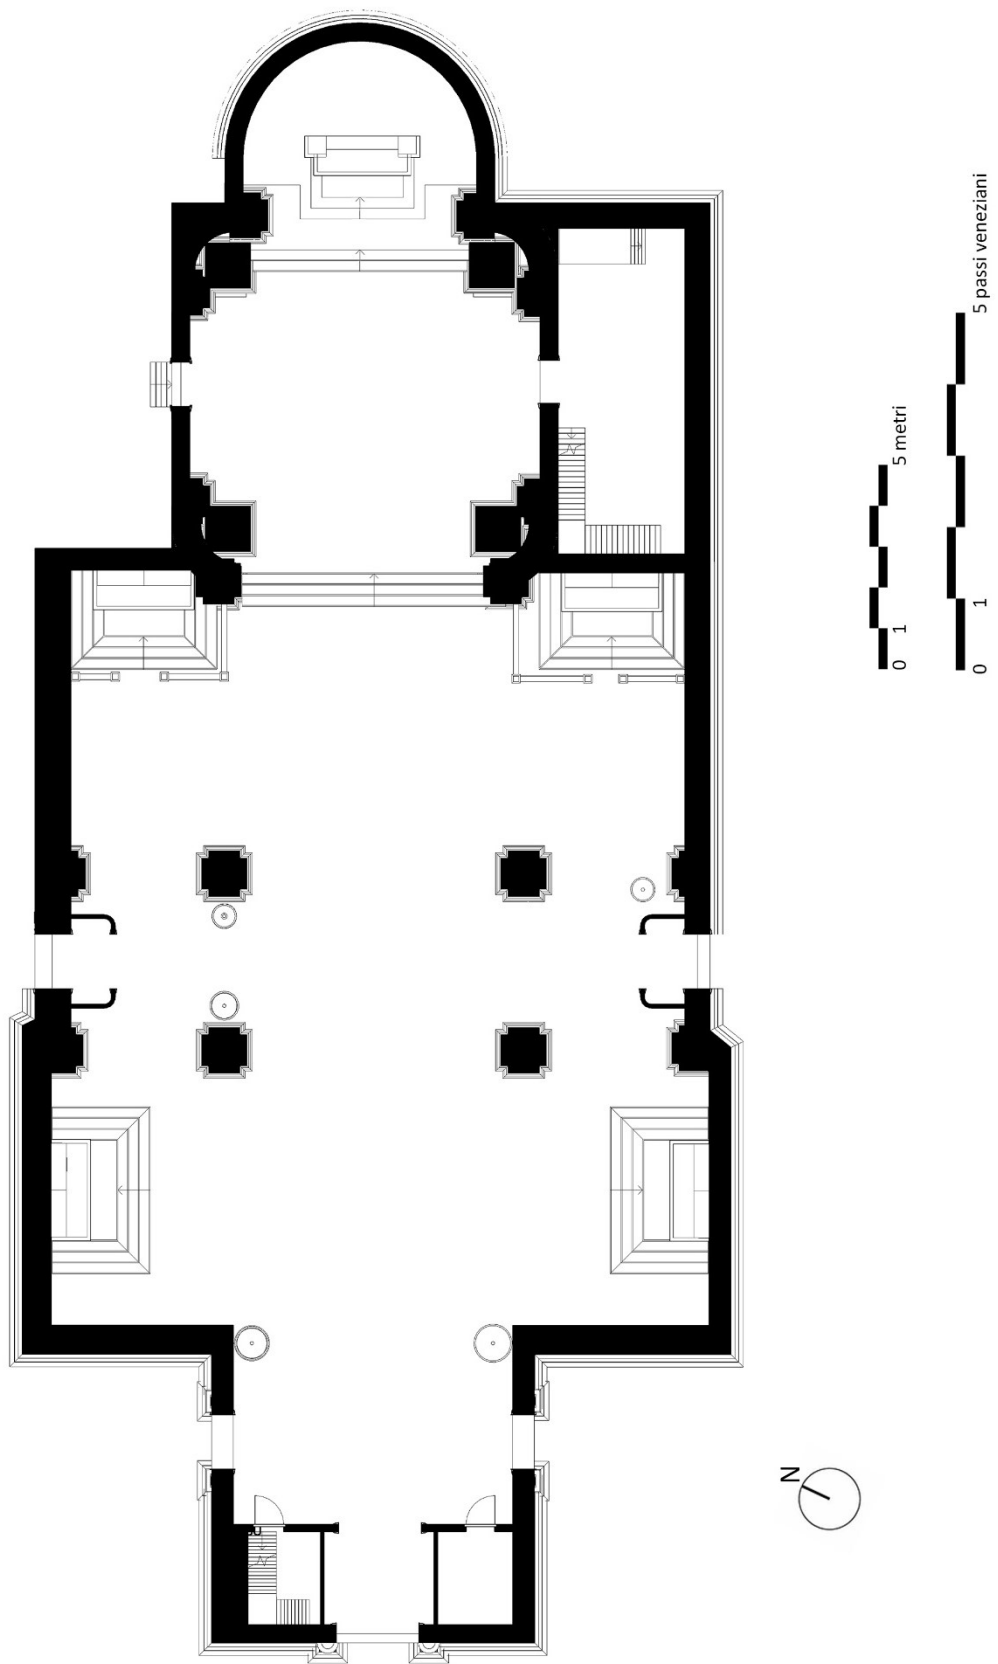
Planimetria dello stato di fatto (elaborazione di C. Zaramella).
